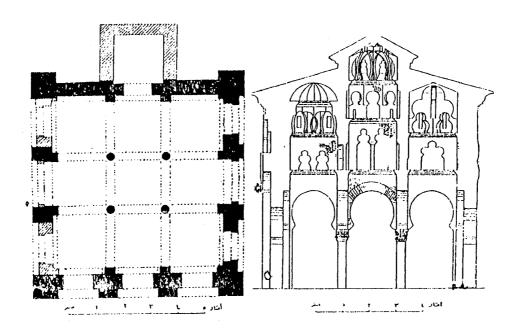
مسقط أفقي لمسجد السيدة بالمنستير بتونس . (عن : Marcais) .
